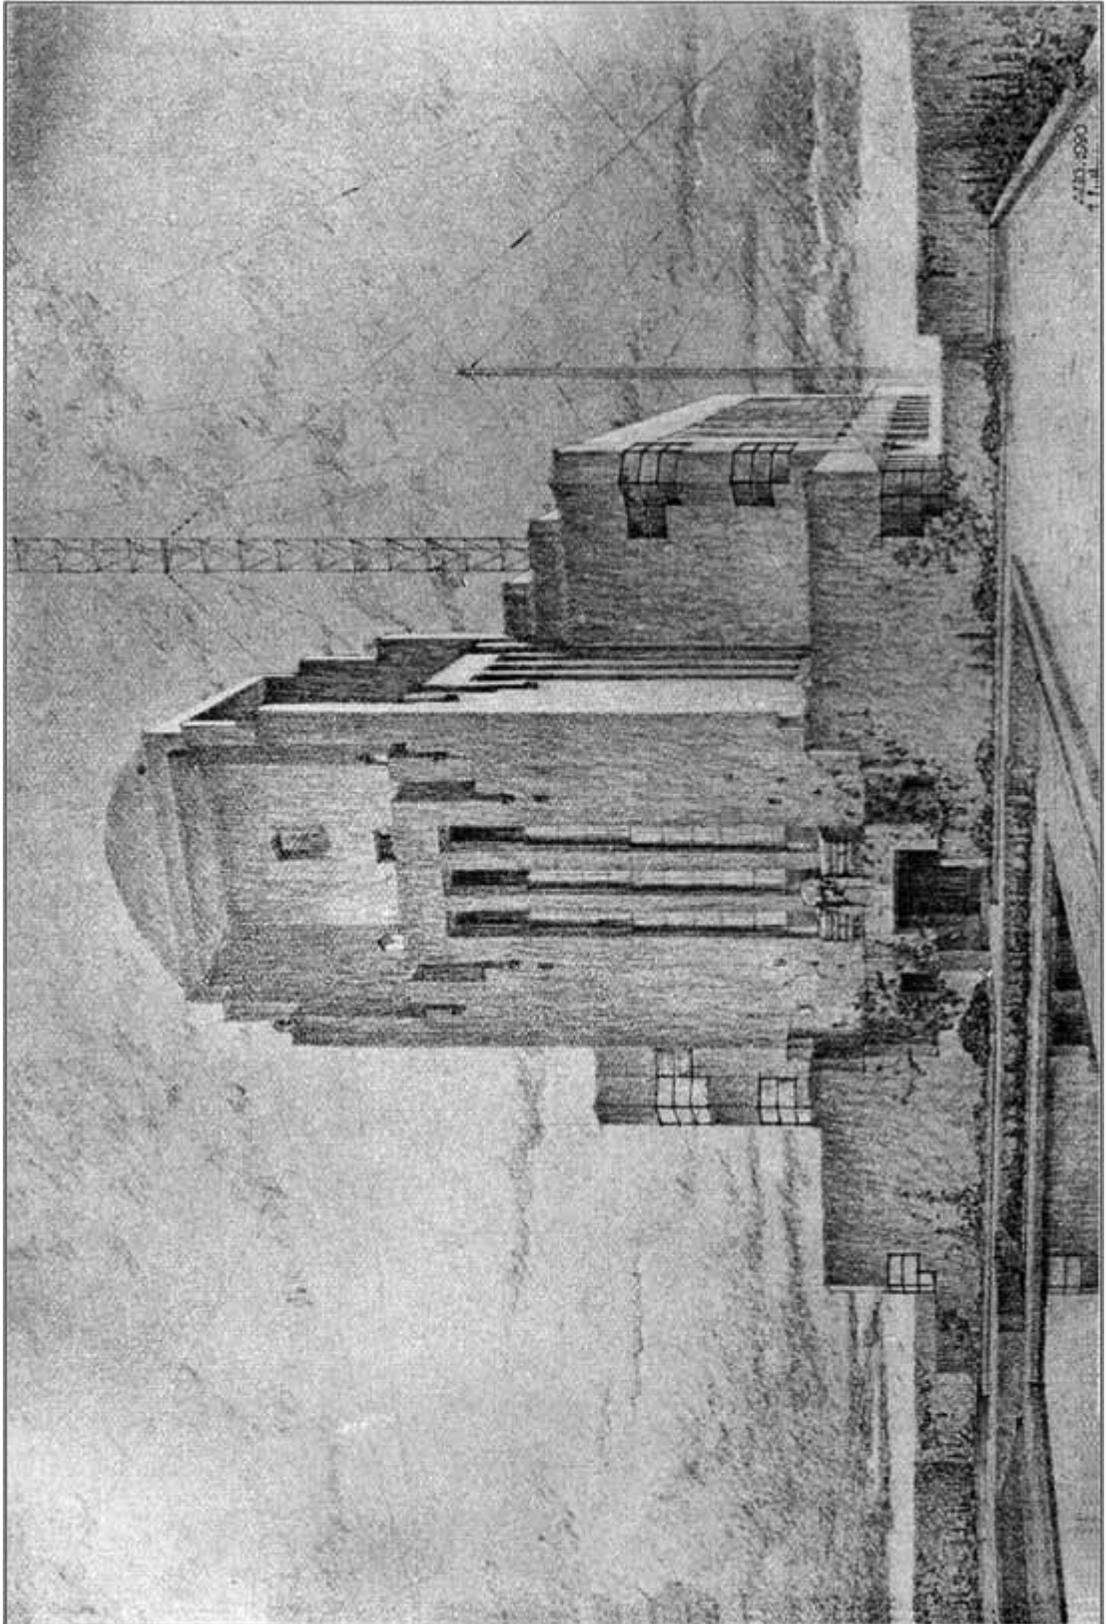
Stationsgebäude der im Bau befindlichen Telefunken-Großstation Assel (Holland)
